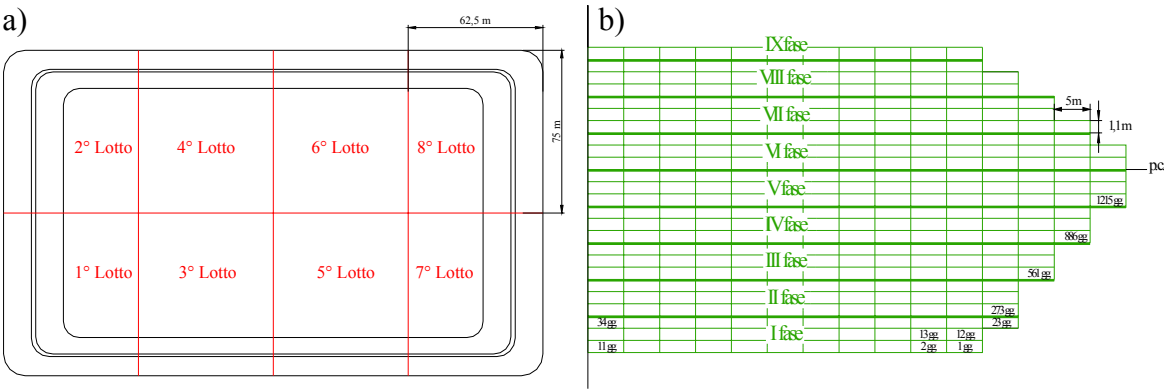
Vista in pianta (a) e in prospettiva (b) della discarica di progetto e successione di abbancamento delle singole celle
